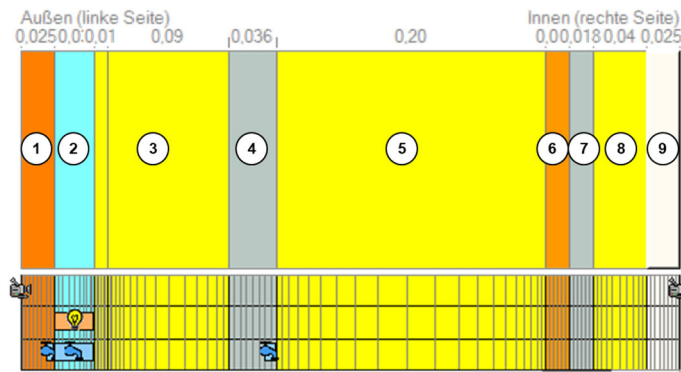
Skizze Detailschnitt Außenwandaufbau (SMP, 2018)
